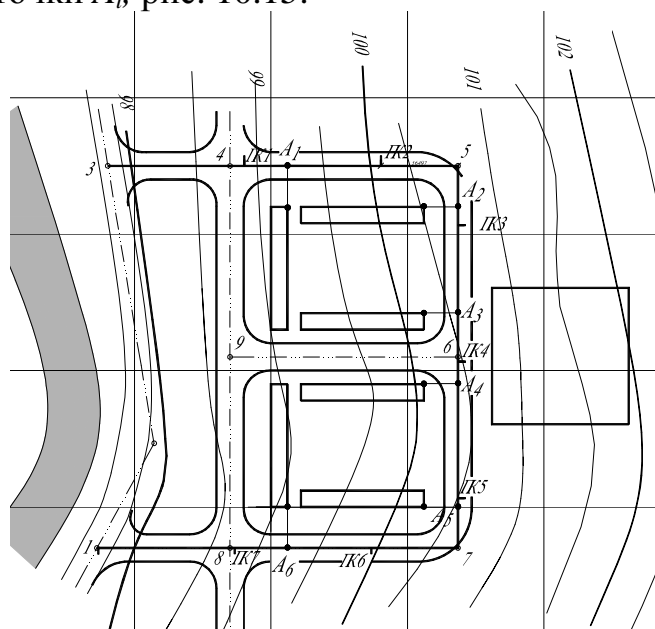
Схема створных точек для расчета отметок пола первого этажа зданий
